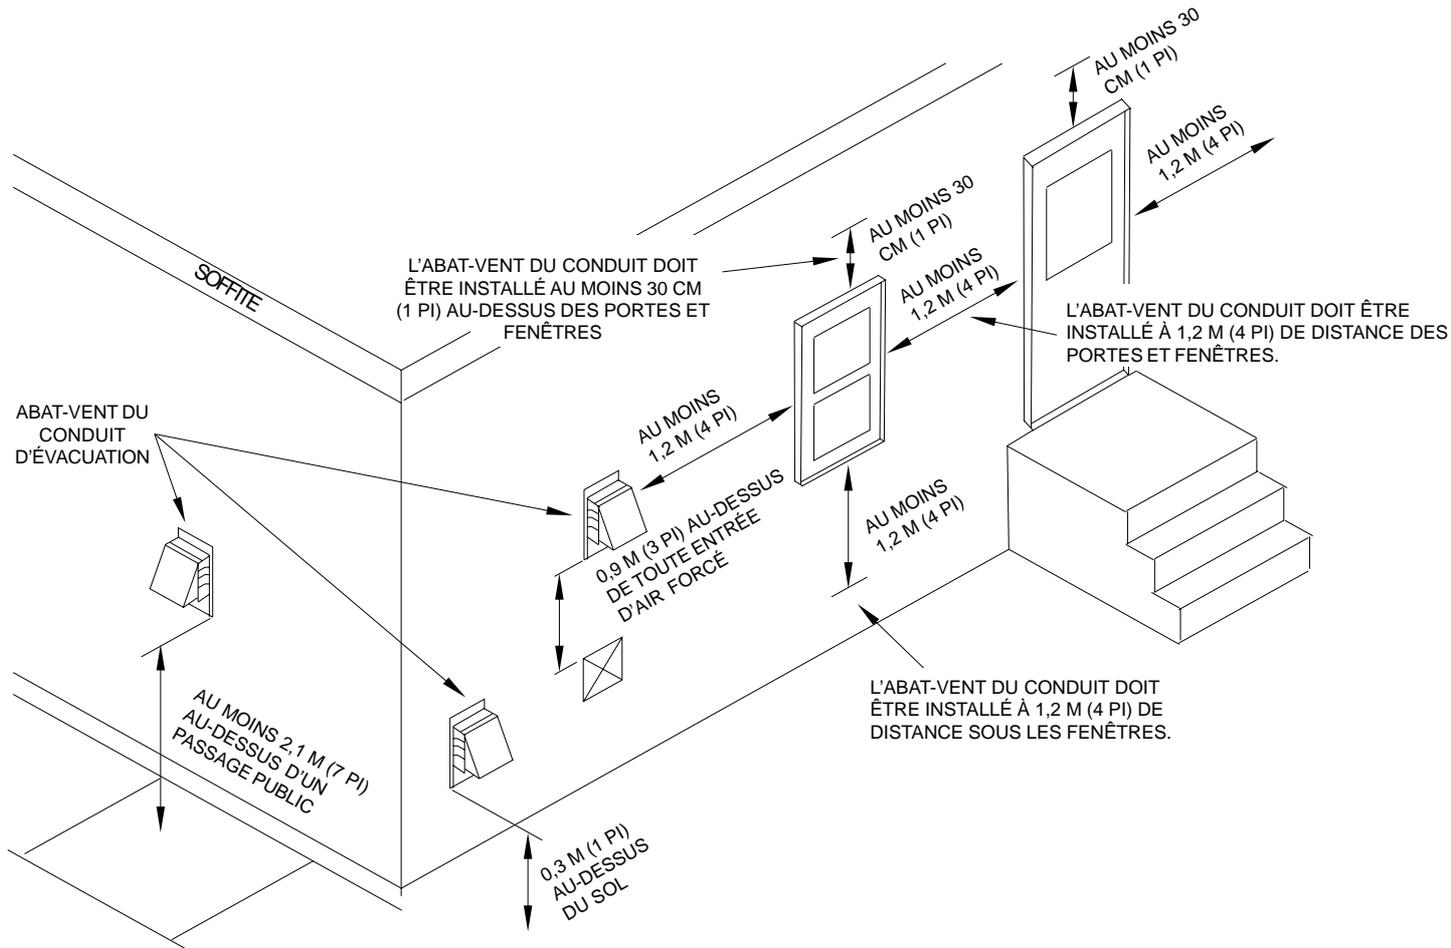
Emplacements des terminaisons de conduit d'évacuation mécanique sur un mur latéral
